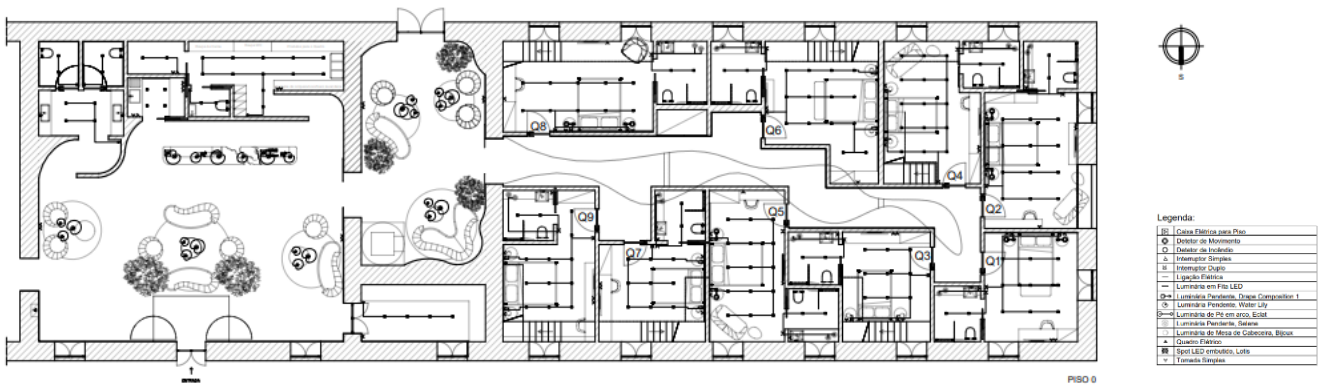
I - Planta de Iluminação, Piso 0, Alojamento Olive
